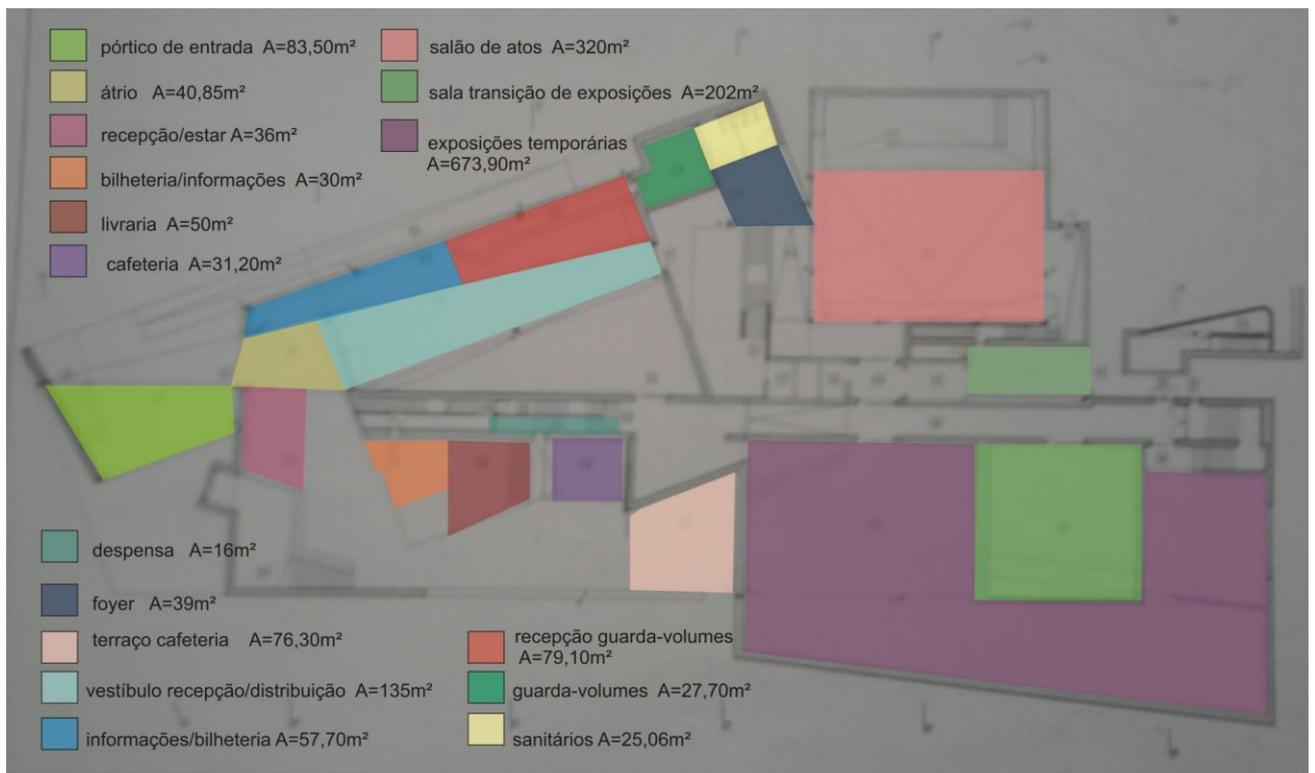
Planta Baixa Pavimento Térreo (TRIGUEIROS, 1995).
